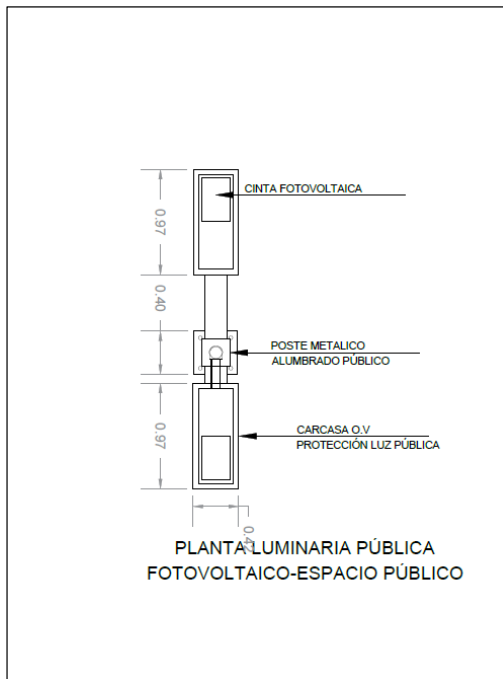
, *Vista en planta del detalle técnico constructivo de la luminaria pública.
